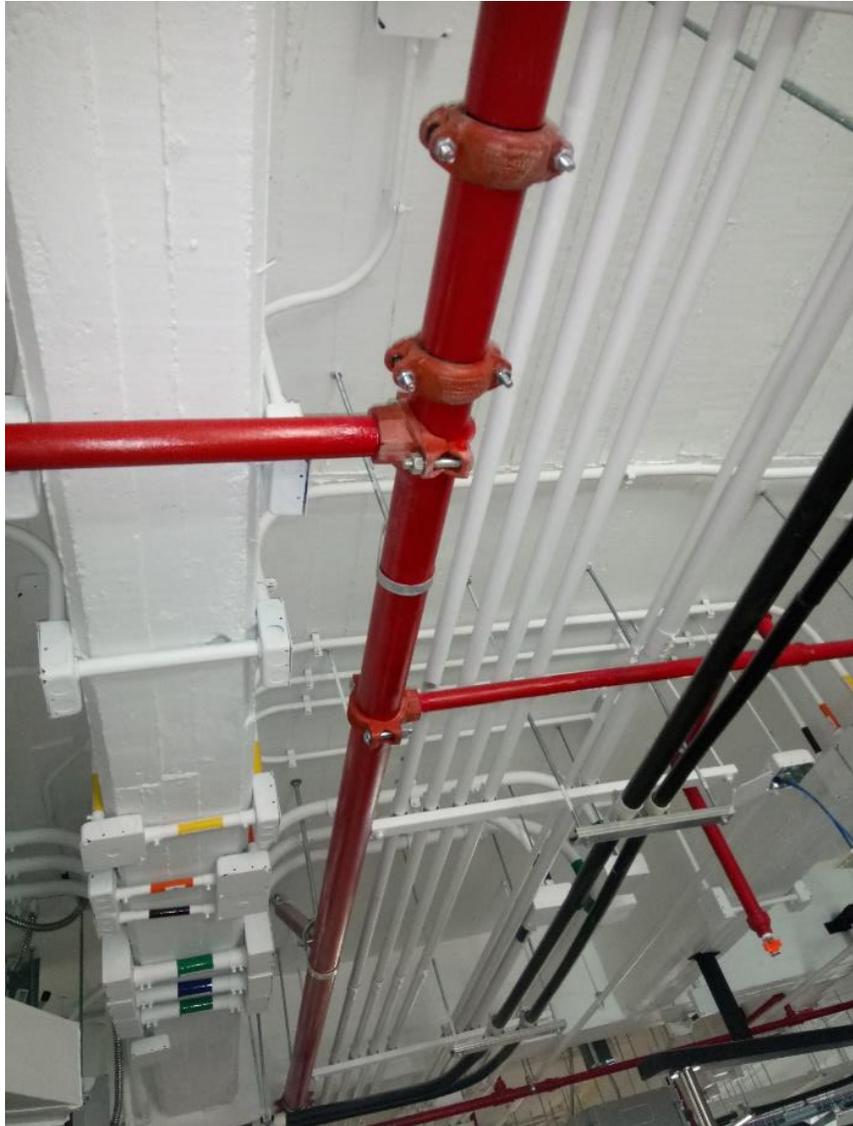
Soportería en ramal. Fotografía tomada en sitio.
